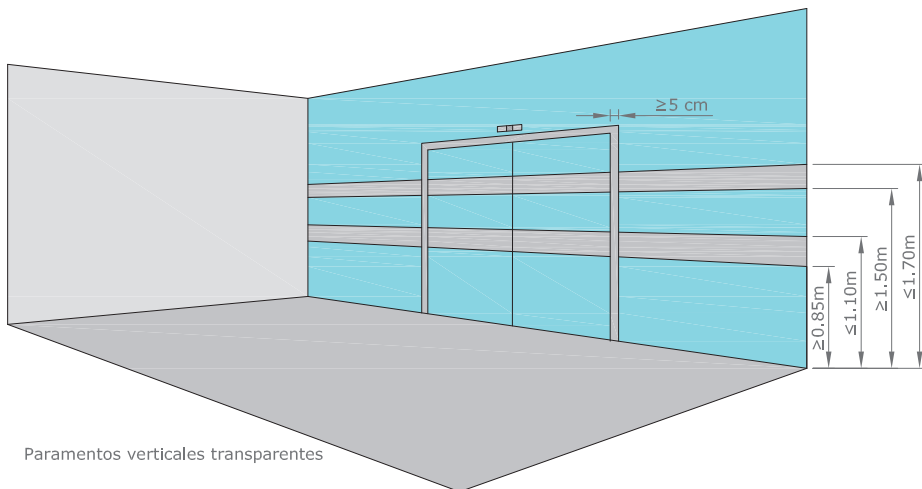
Detalle de un paramento vertical transparente con puerta.
